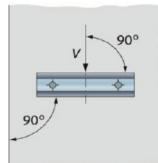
剪力方向与混凝土基材边缘平行示意图
